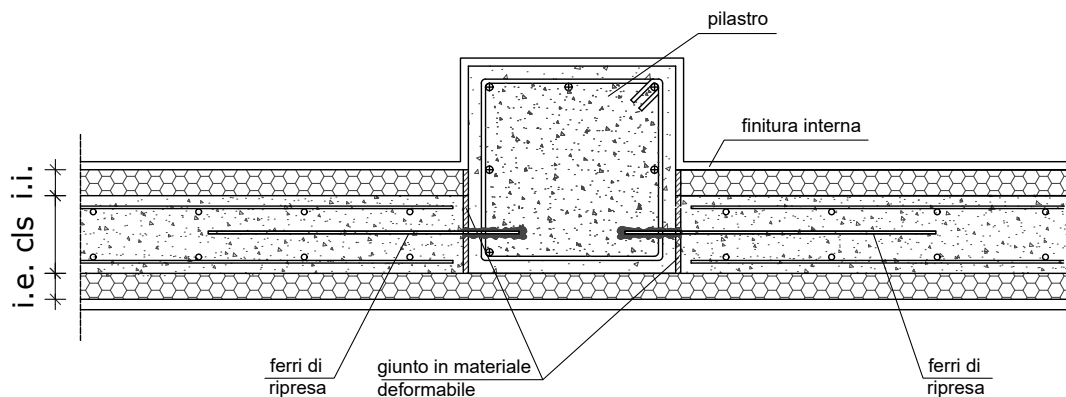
Pianta di una parete di tamponamento realizzata in ICF che si collega ad un pilastro che "marca" sull'interno.
